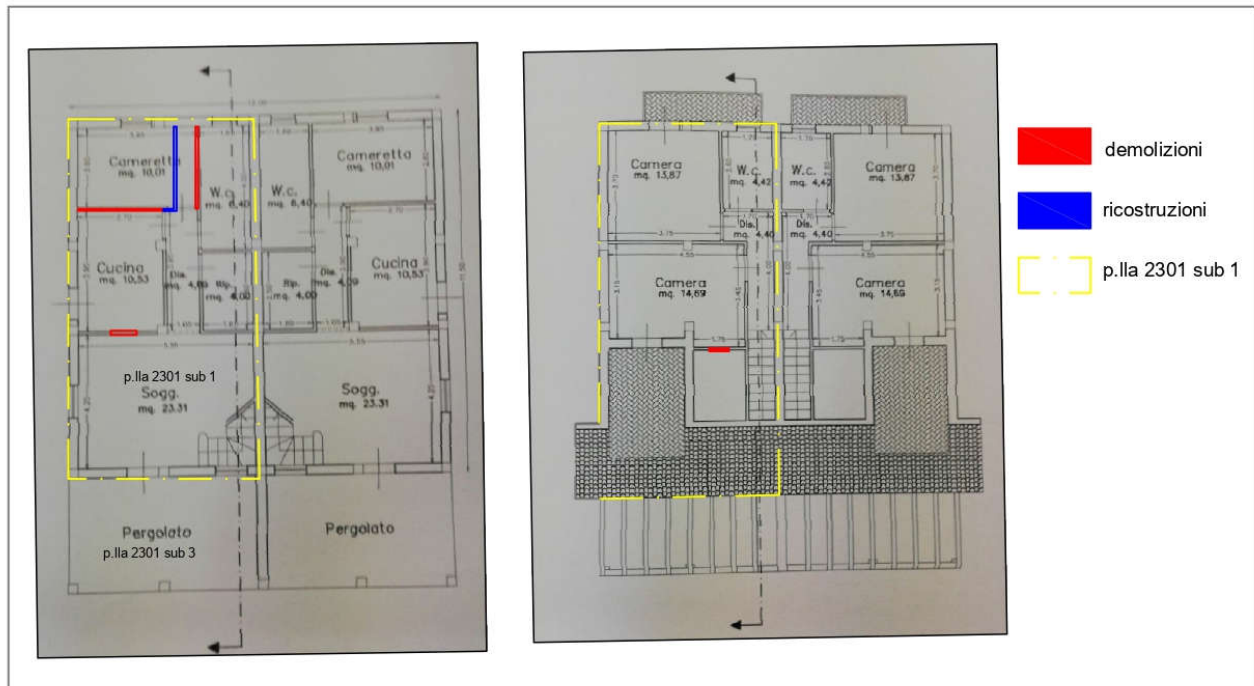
Piante del progetto assentito recante le modifiche apportate e corrispondenti allo stato attuale
